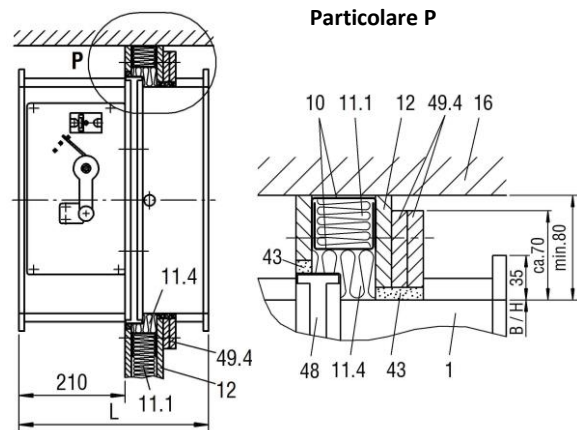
montaggio a secco in pareti divisorie leggere (F30/F60) direttamente sotto soffitti massicci
